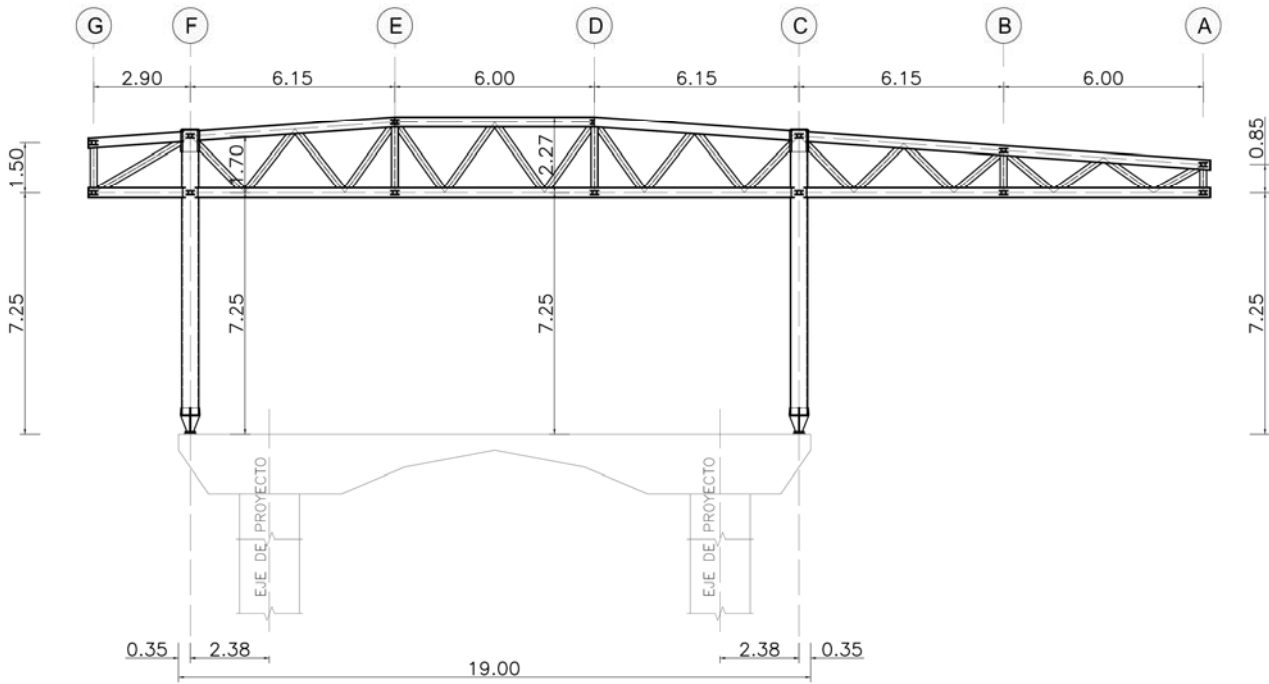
Pórtico transversal tipo de la estructura de cubierta.
